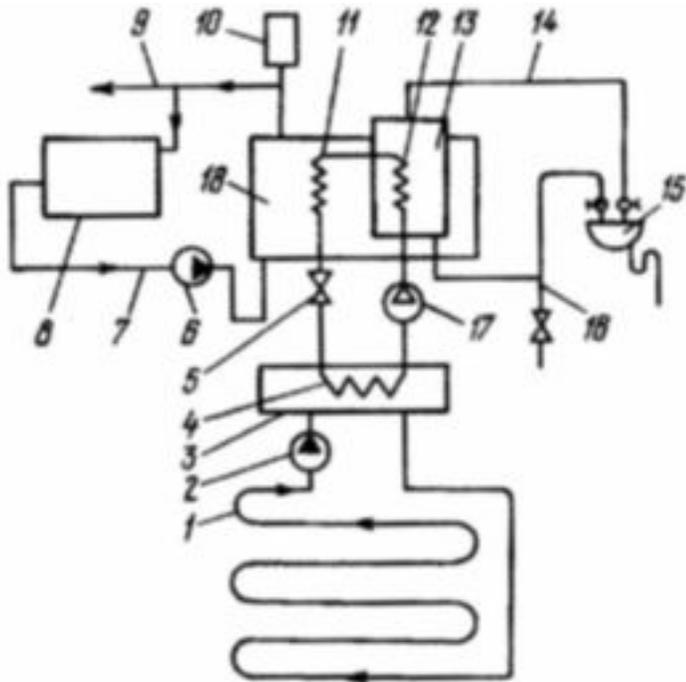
Принципиальная схема петротермальной системы теплоснабжения жилого дома:
